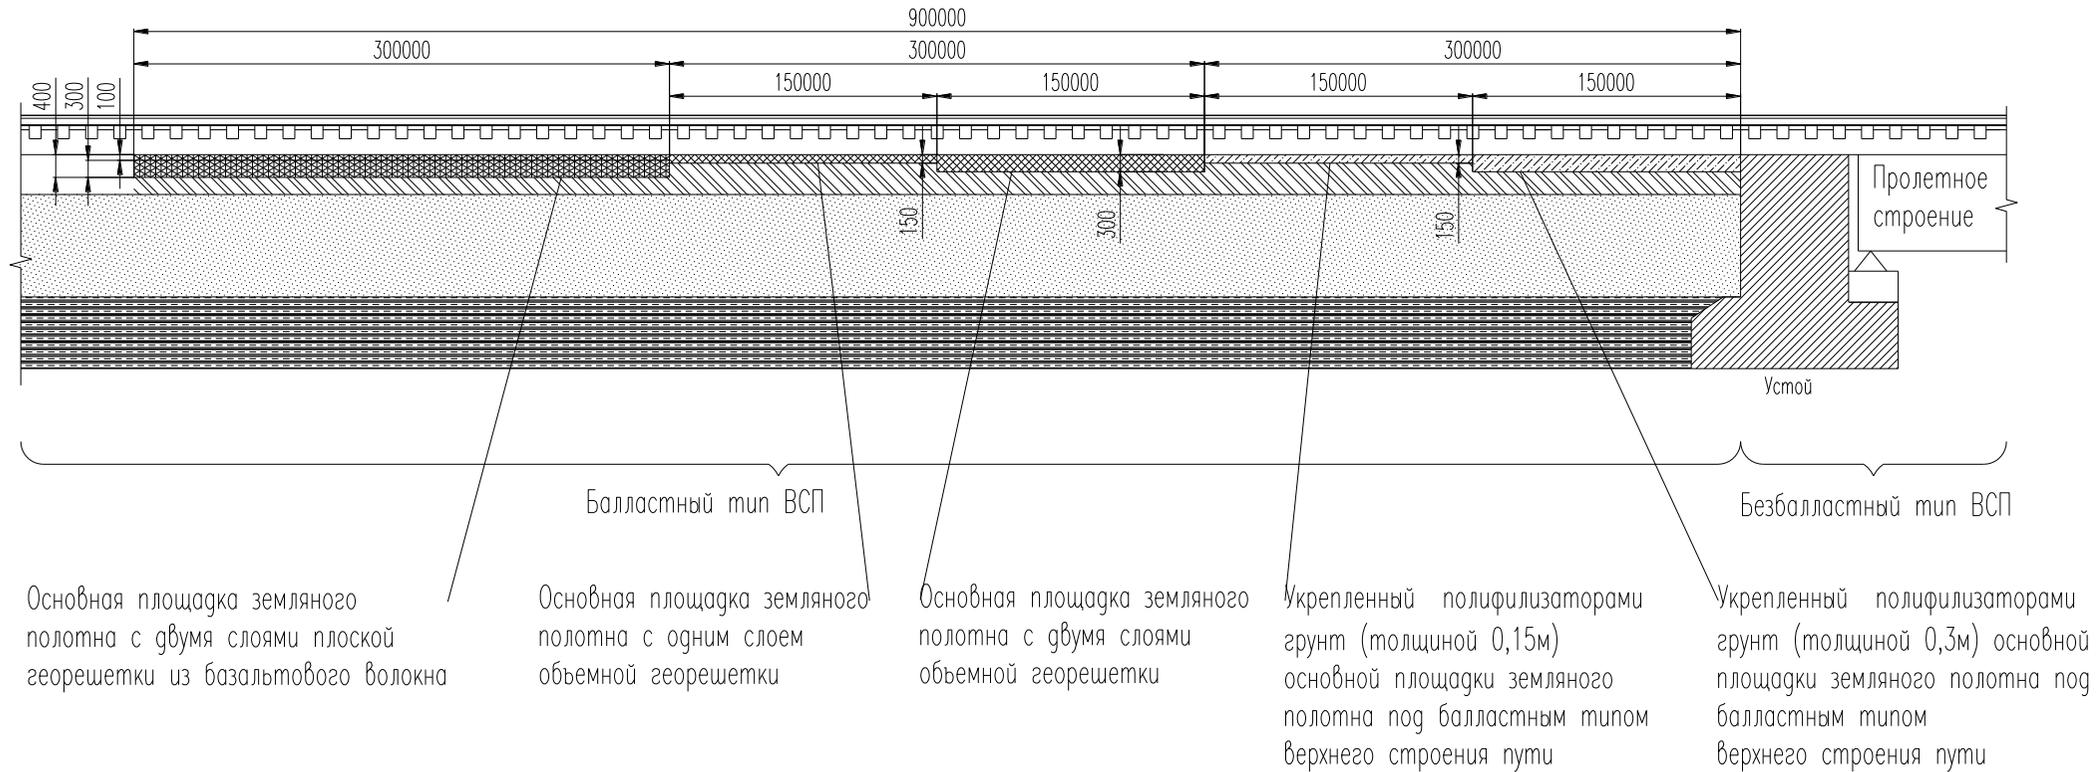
Схема укрепления грунта основной площадки земляного полотна на переходном участке перед пролетными строениями
